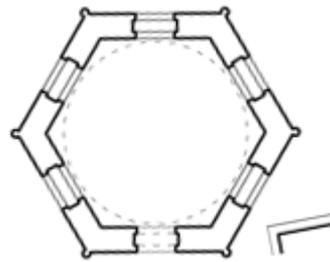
مسقط أفقي لترتبة سنان باشا في البوسنة عن:
